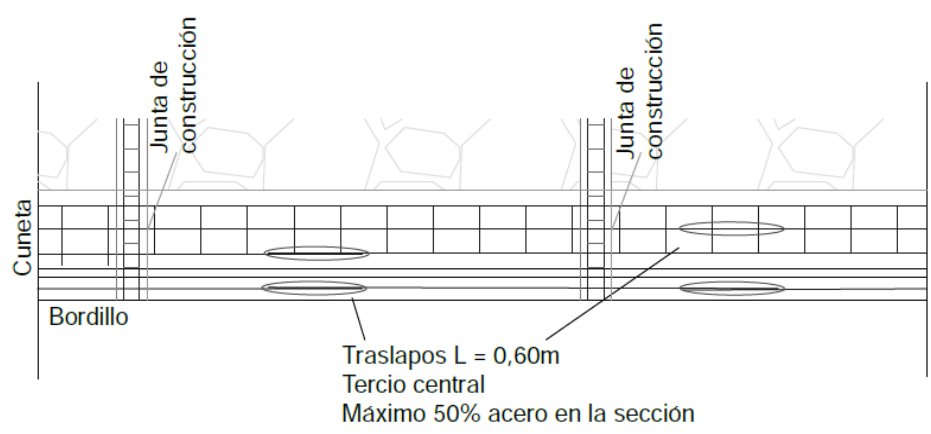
Junta transversal de construcción de berma-cuneta (vista en planta).
